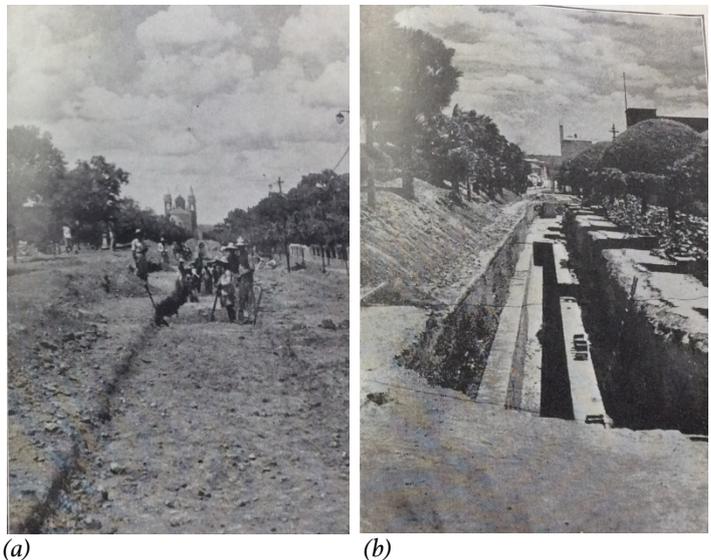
(a) Escavação da Avenida Frei Serafim para construção da galeria de águas pluviais, no ano de 1941. (b) Construção da galeria de águas pluviais na Avenida Frei Serafim, em 1941.
